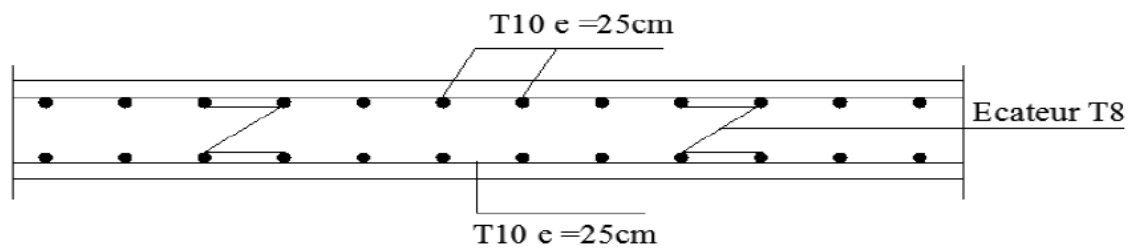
Ferrailage de la dalle pleine du sous-sol.
